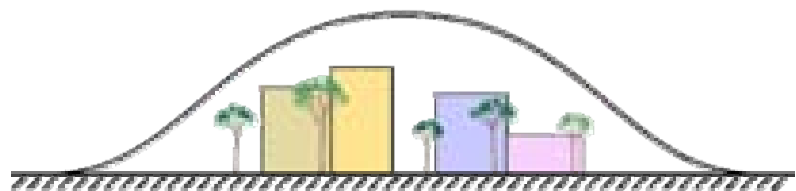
Perfil exterior de la cubierta estructural propuesta.
